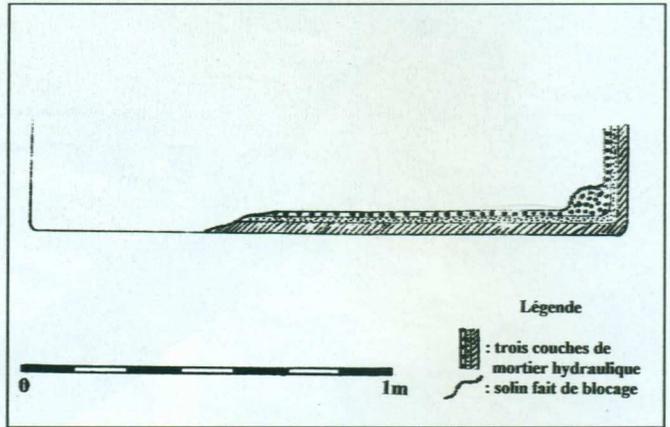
conduite "isolée" sur le rivage de Sidi Daoud
